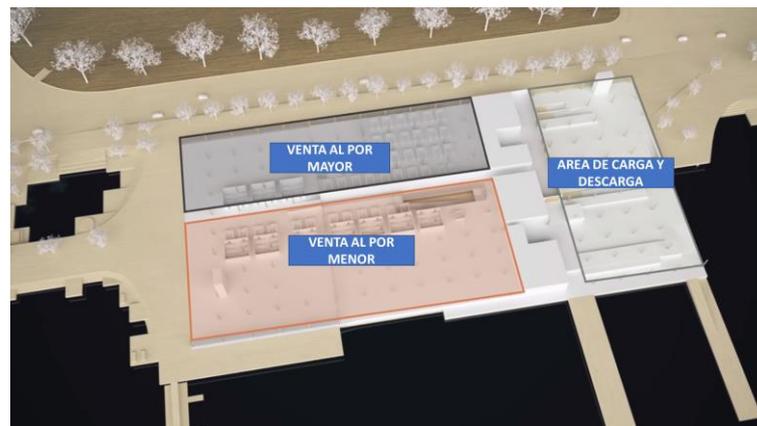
Planimetría del nuevo proyecto de del mercado Sidney Fish Market
